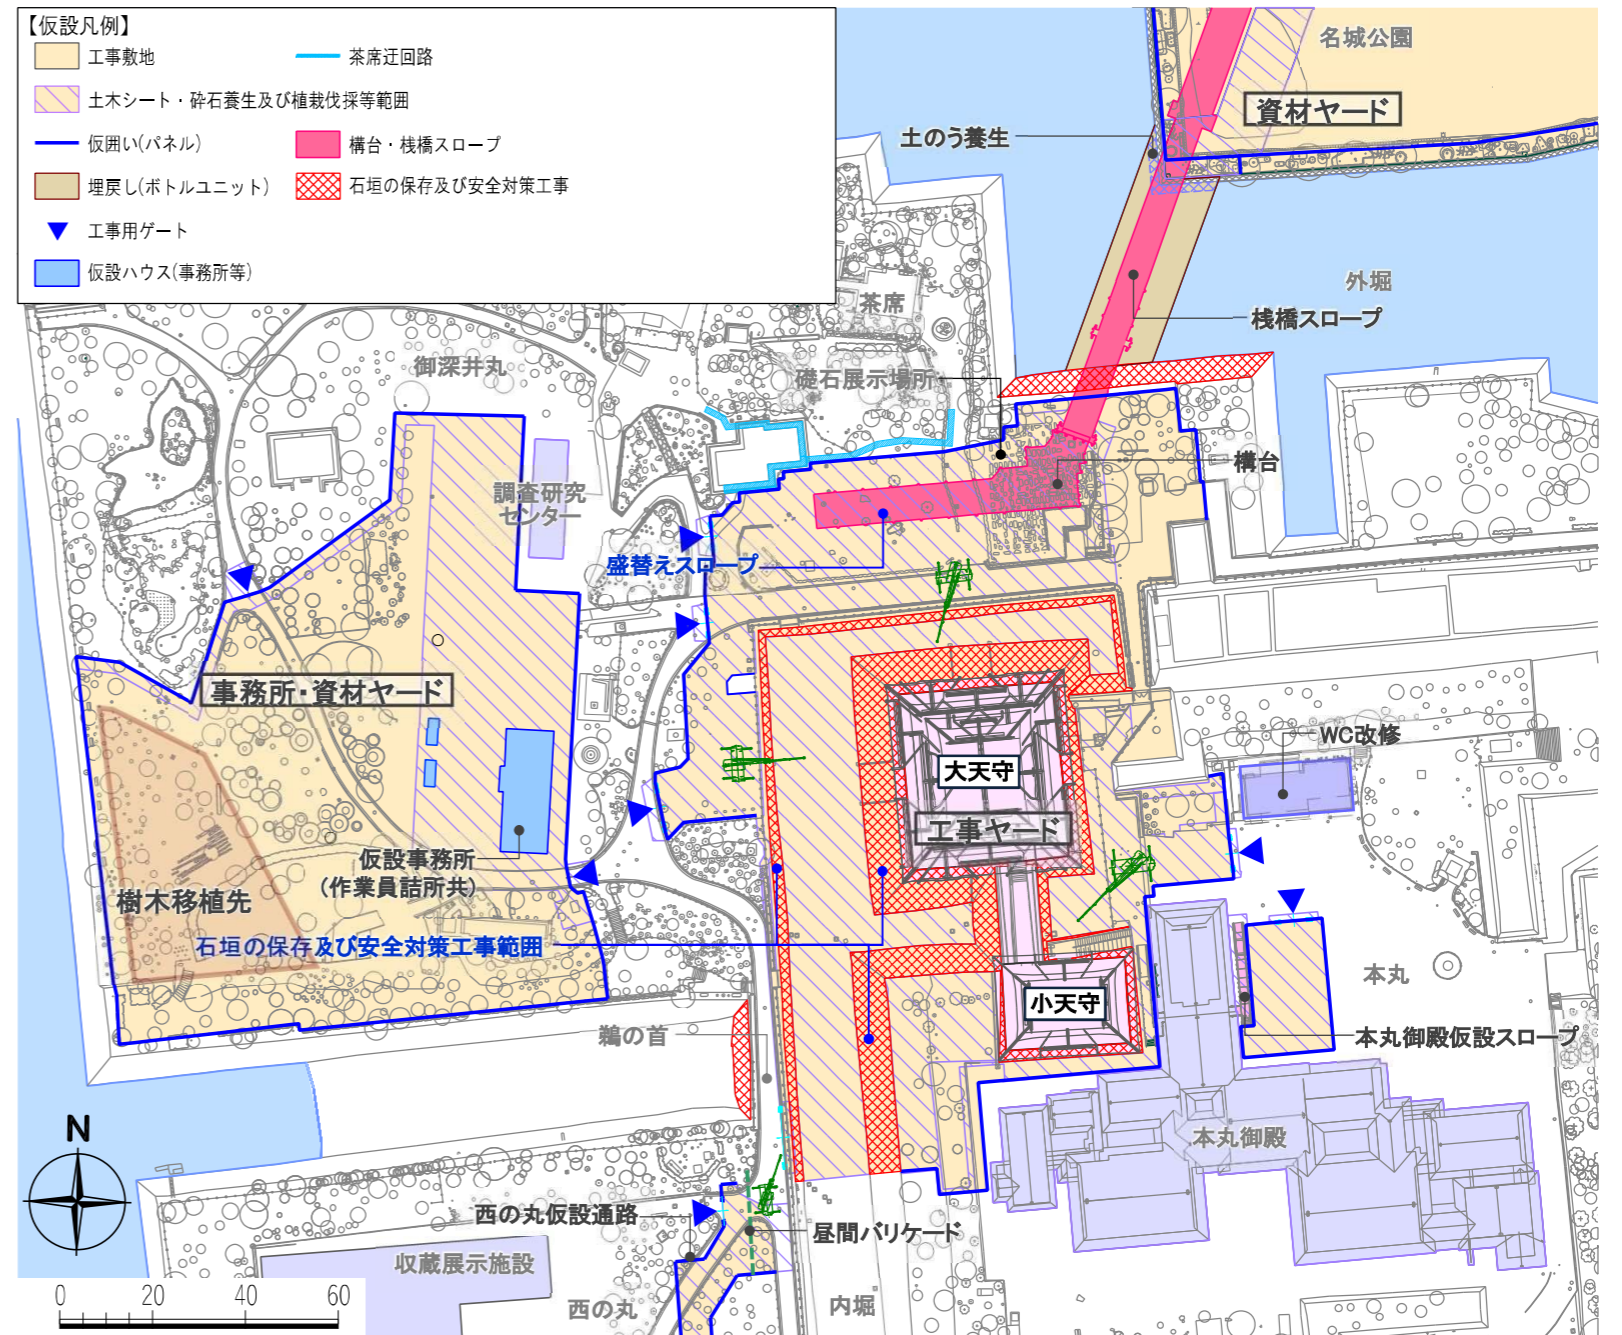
石垣の保存及び安全対策工事時の平面図
